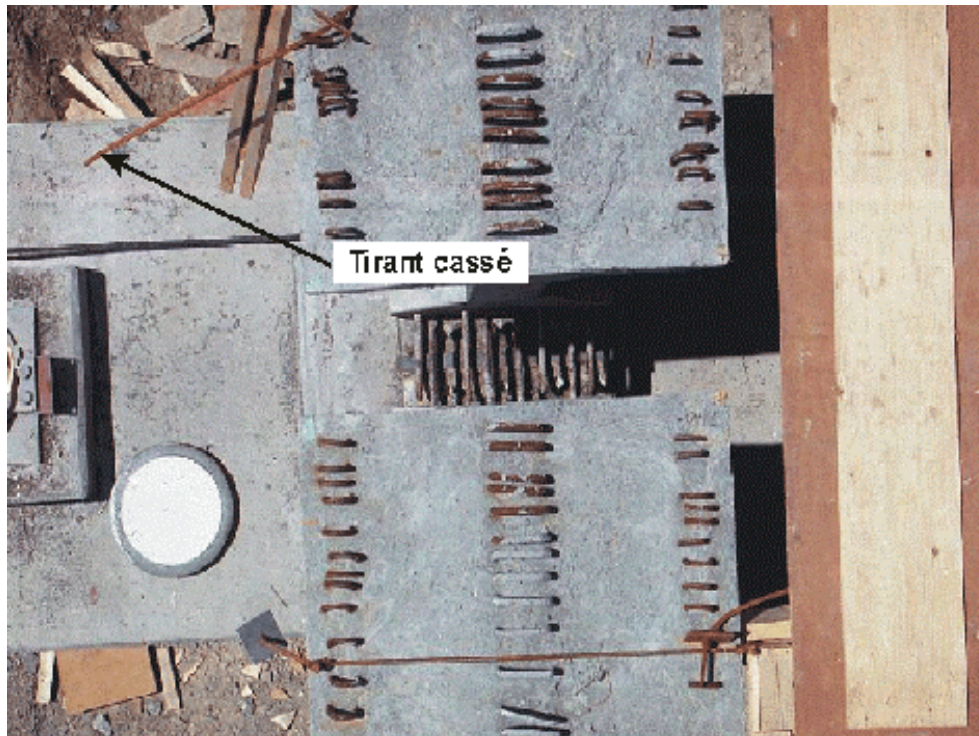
Vue rapprochée du bout des poutres de la travée 1 à la pile 2
